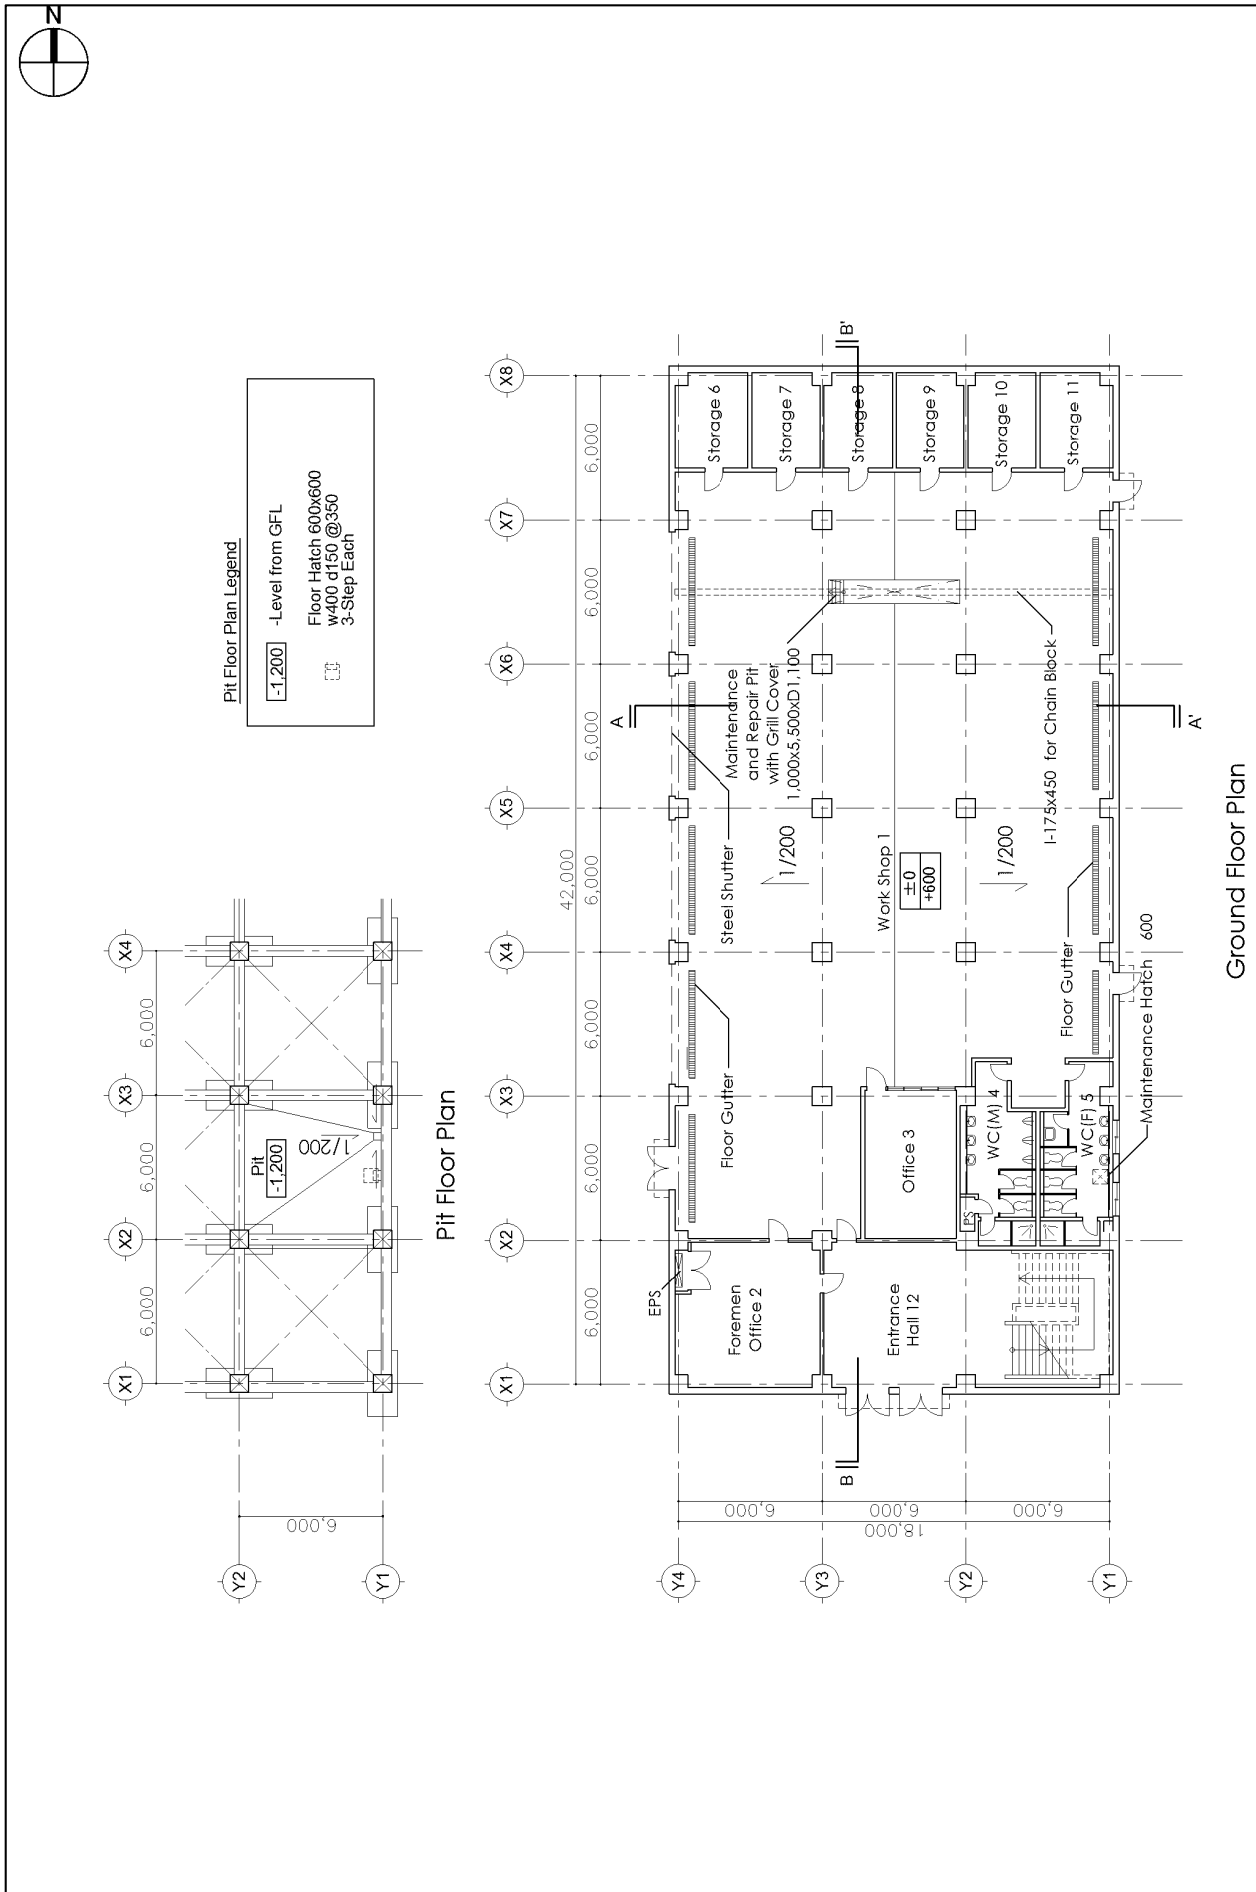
港湾事務所／ワークショップ 1 階 (ワークショップ) 平面図
